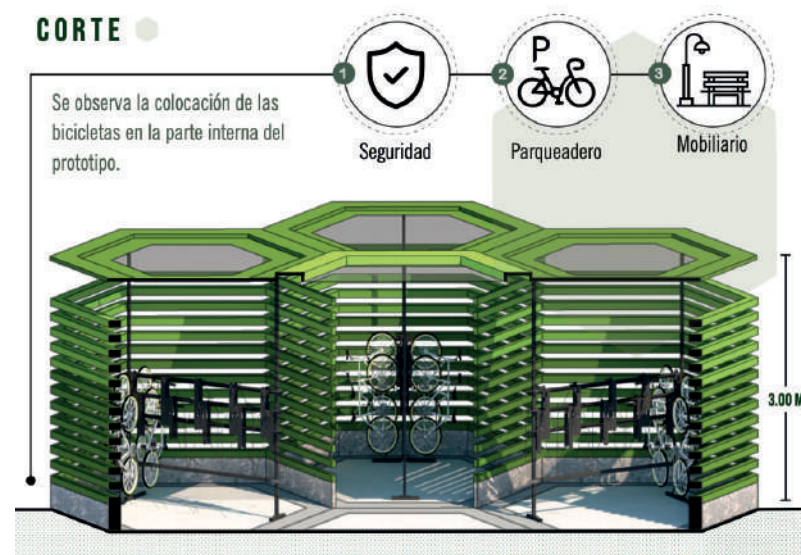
◀ Corte arquitectónico del ciclo-parqueadero.
